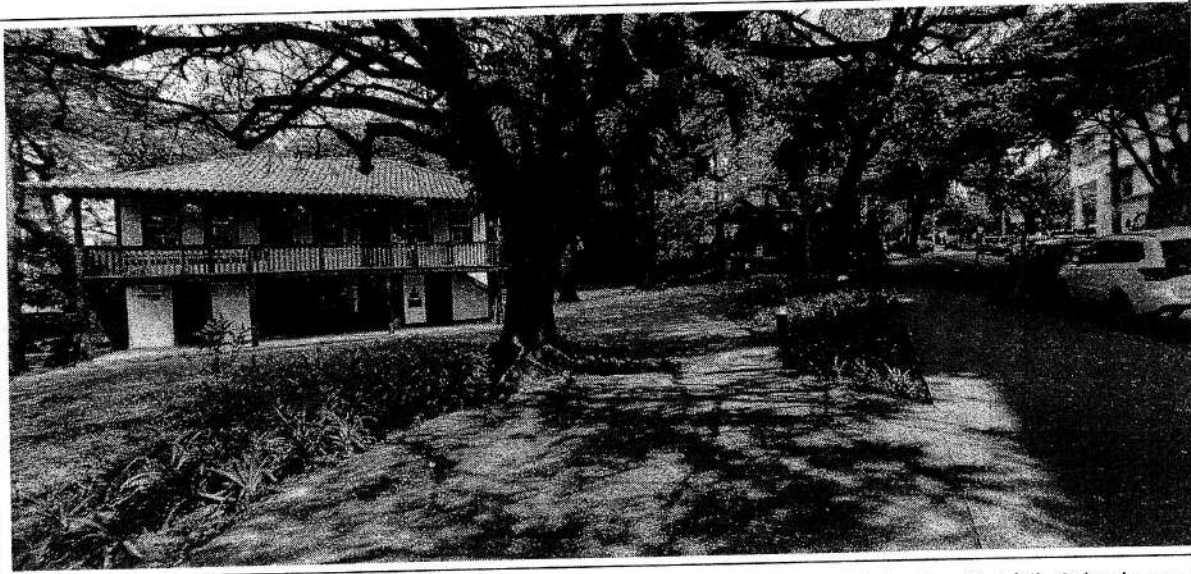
Circulação área externa – piso nivelado bem conservado, não possui sinalização tátil. Calçada rua Bernardo Mascarenhas com piso bem conservado
